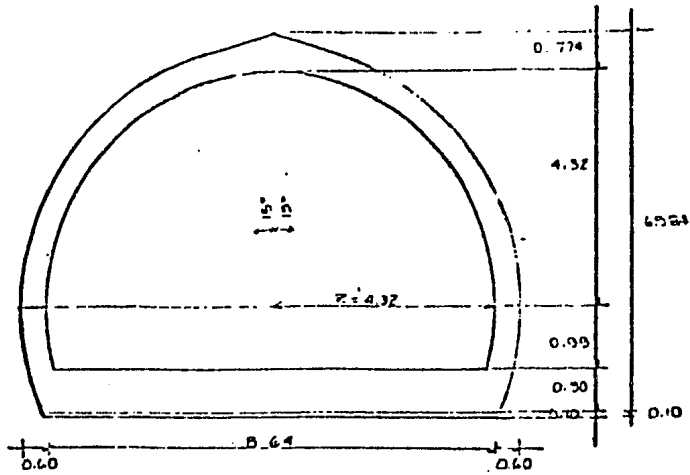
b SECCION TRANSVERSAL TIPO 2
